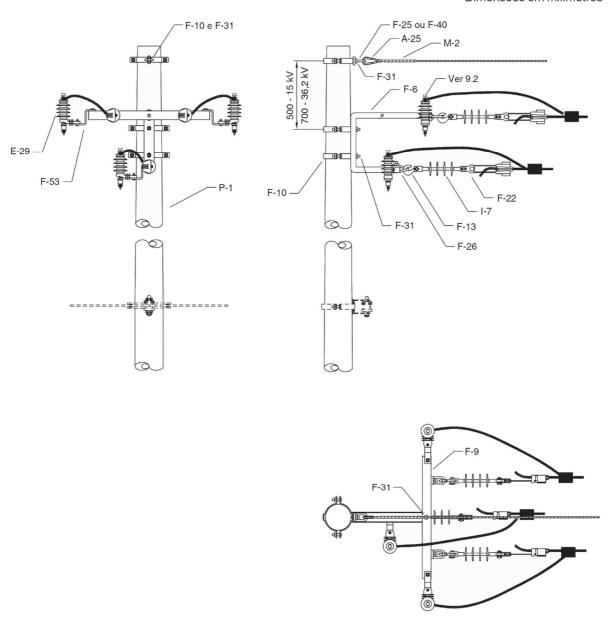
Estrutura CE3 PR – Poste de concreto de seção circular
